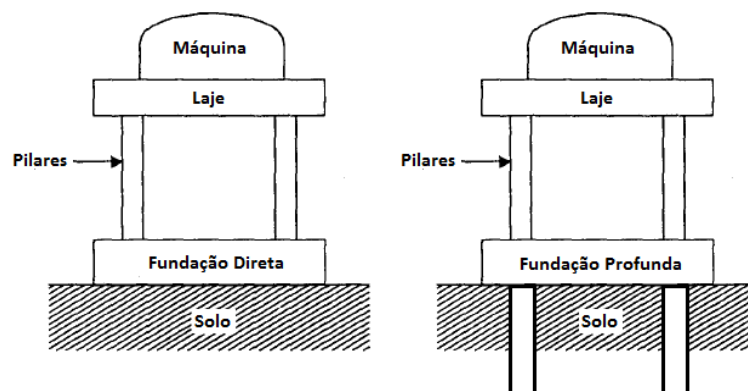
Exemplos de sistema estrutural aporticado de suporte de equipamentos
